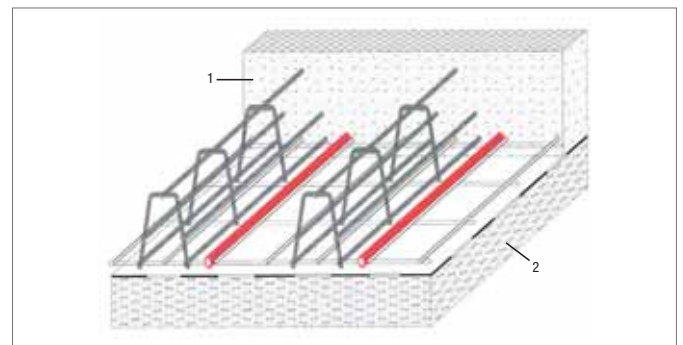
Solera de hormigón armada con mallas de acero; construcción especial con tubos de calefacción montados en el centro de la solera
